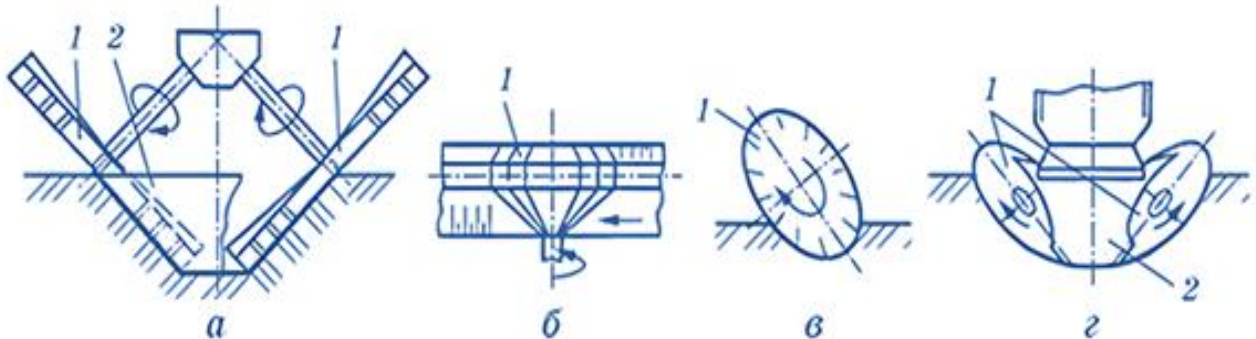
Схеми основних робочих органів каналокопачів: а – двофрезерний (двороторний); б – фрезерний із копіювальною фрезою; в – фрезерний із похилою віссю обертання; г – двомоторний з похилою віссю обертання; 1 – ротор (фреза); 2 – відвал
